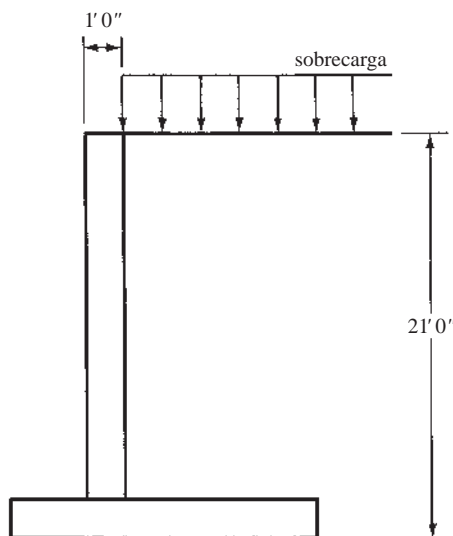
Muro de retención tipo voladizo para el Ejemplo 13.2.
